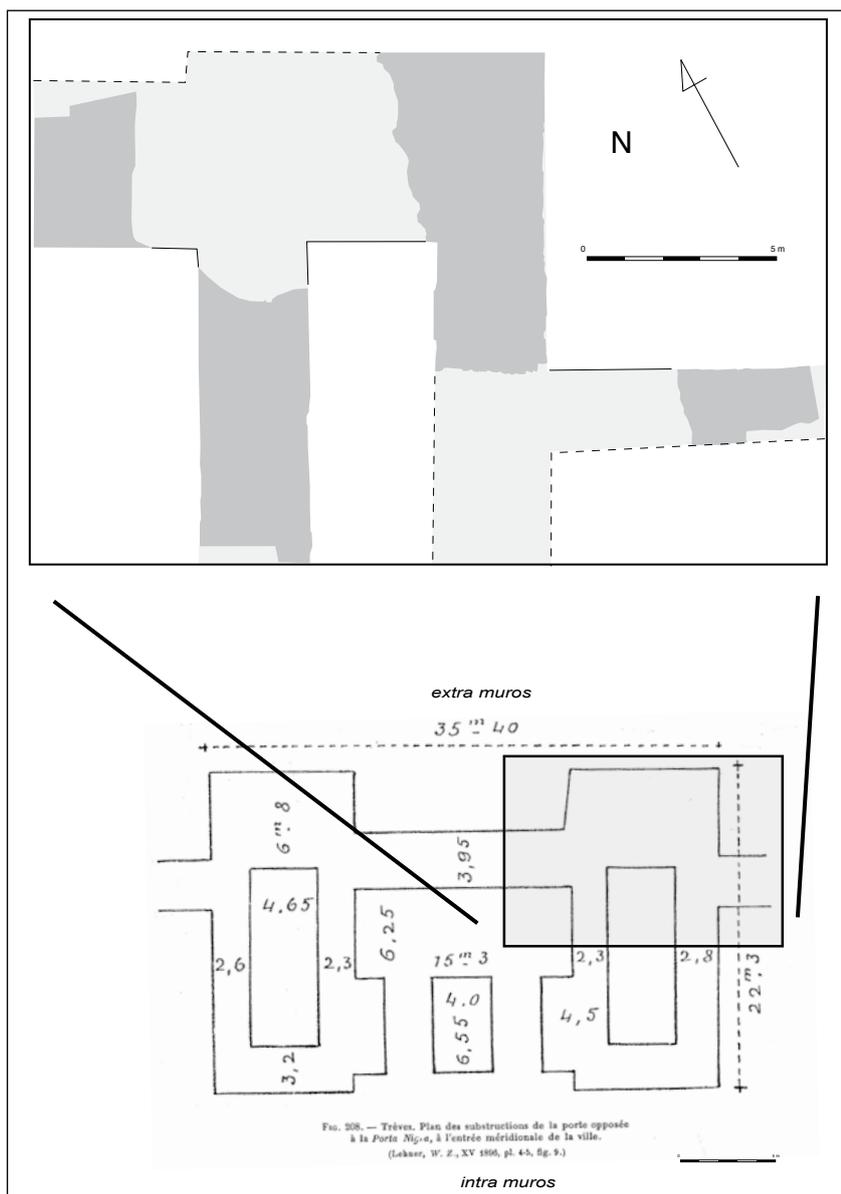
Comparatif entre les plans des fondations des portes de Trèves et de la Butte. Dessin : S. Motte, C. Plantevin et GRENIER, 1931, DAO : F. Vaireaux.
